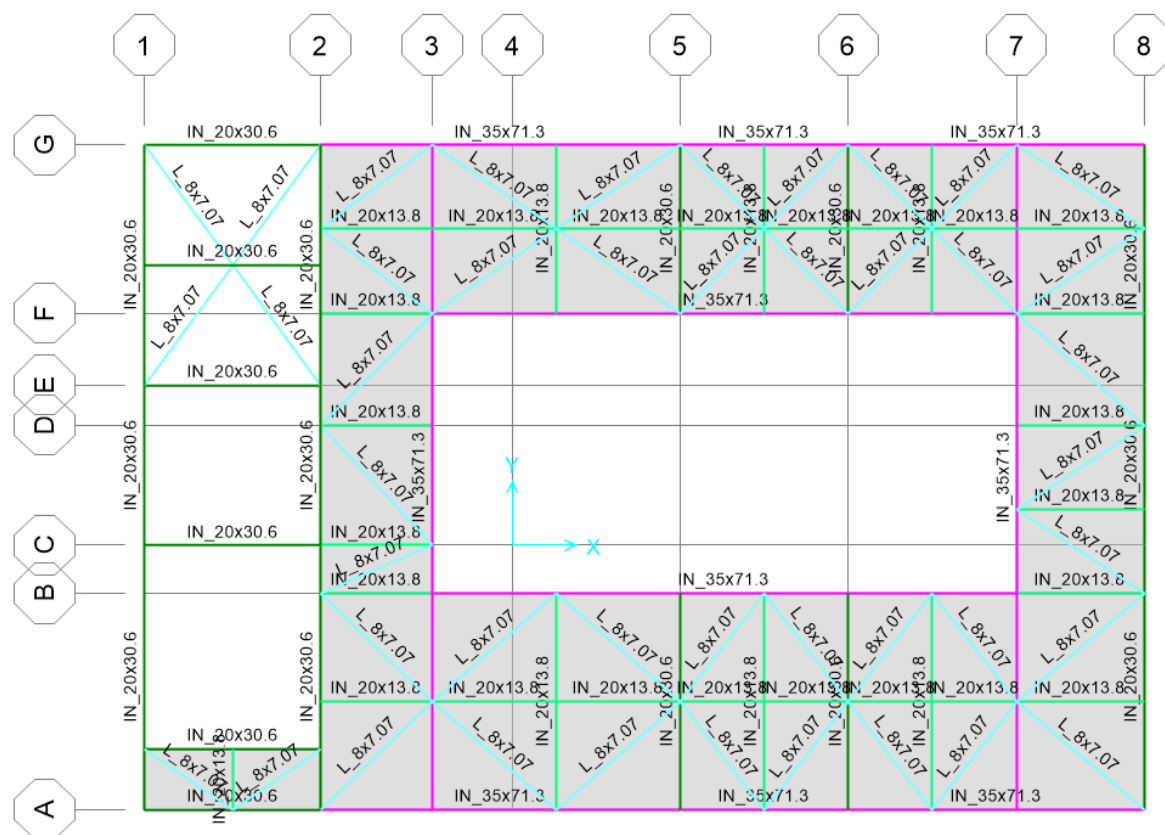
Plataforma servicio 2, plano XY, Z=6.5
